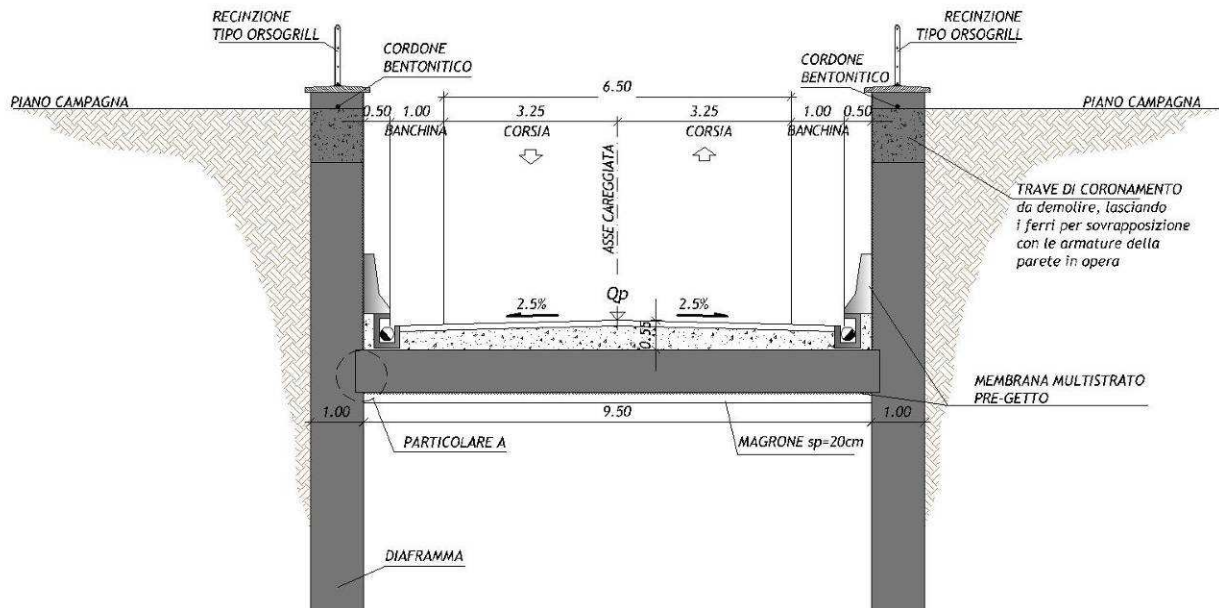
SEZIONE TIPO SCATOLARE APERTO CON DIAFRAMMI
